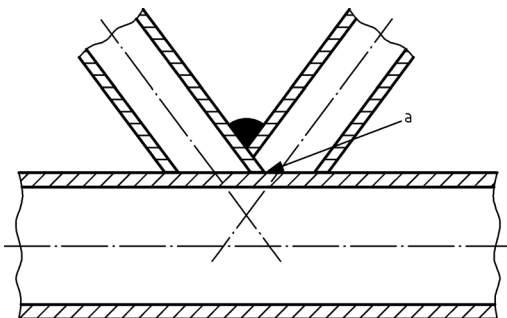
Підготовка та підгонка контурів зварного шва. Кутіві зварні шви у з'єднаннях квадратних і прямокутних порожнистих профілів в'язей із поясом ферми
